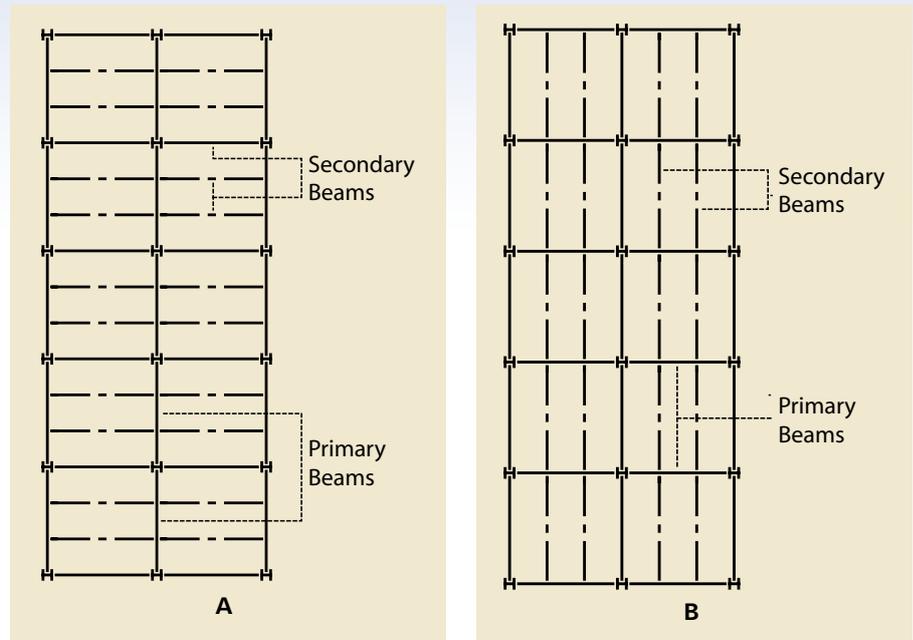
Implantación alternativa para las vigas en construcción mixta
